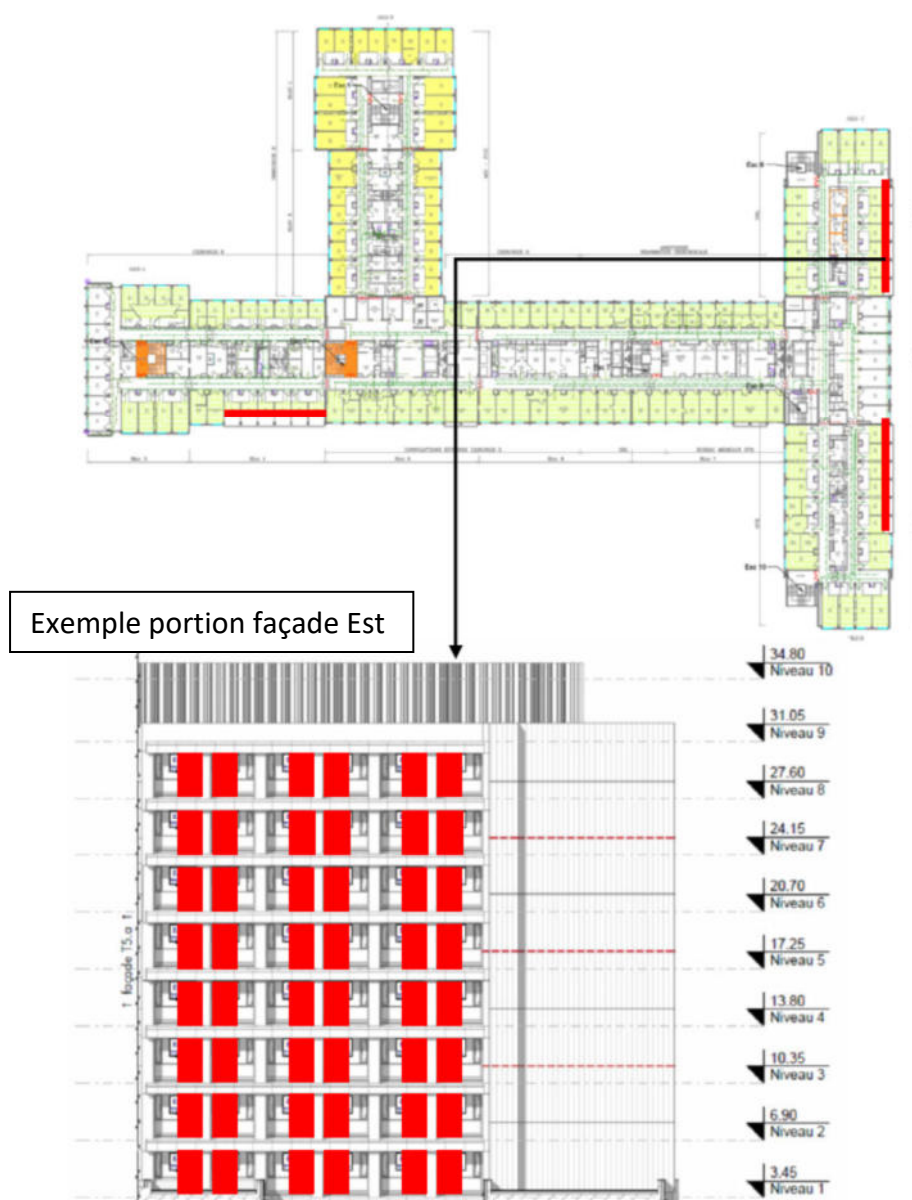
Zone de traitement de l'enduit de façades au droit des loggias
